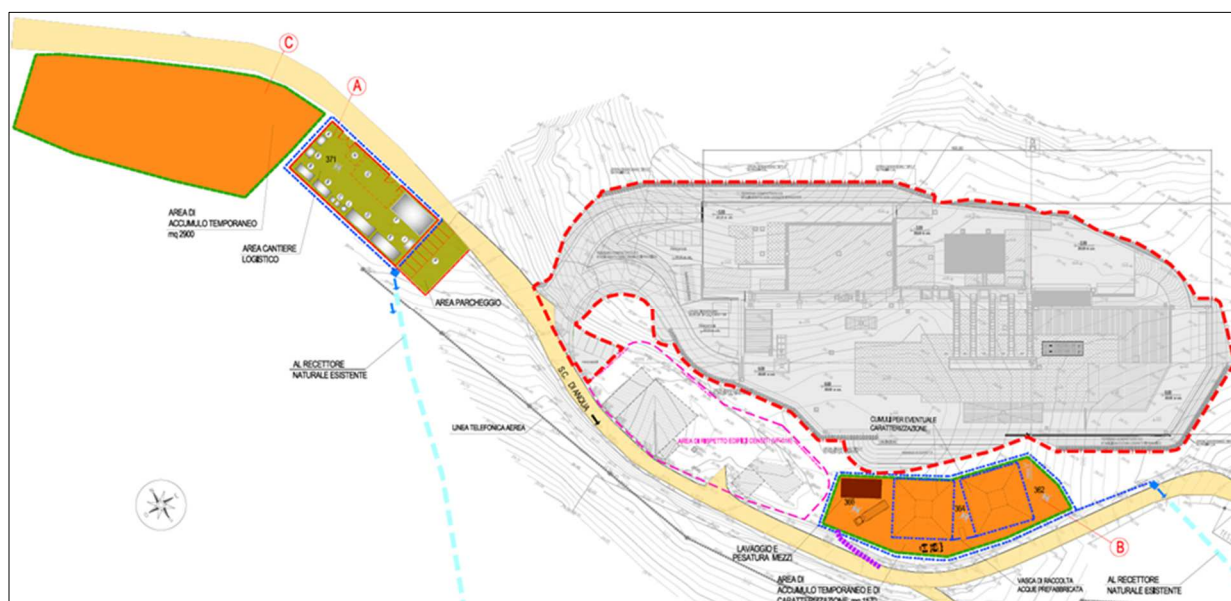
Stralcio della tavola GRE.EEC.D28.IT.G.13407.00.04.005. Planimetria e pianta cantiere civile.
